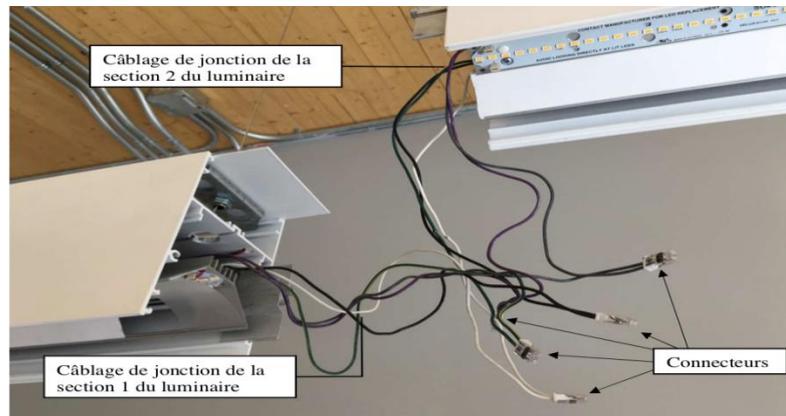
Câblage de jonction des sections 1 et 2 du luminaire
